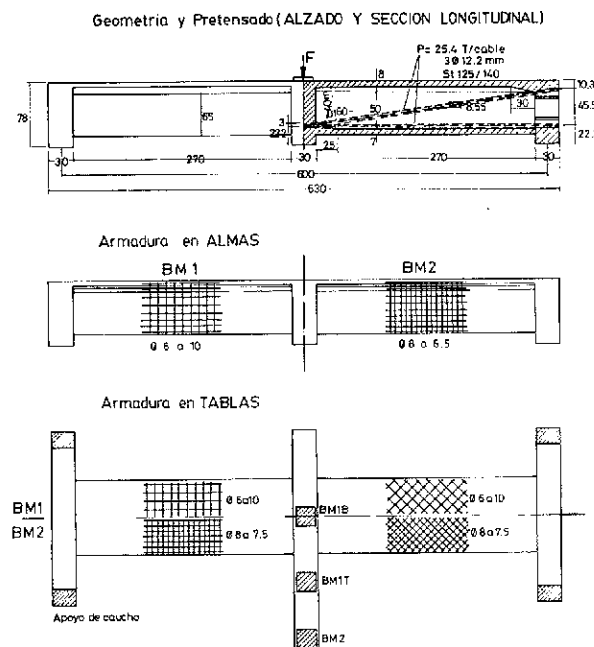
Geometría y disposición de armaduras de las vigas BM1 y BM2, ensayadas en 1963 por F. LEONHARDT y R. WALTHER.
